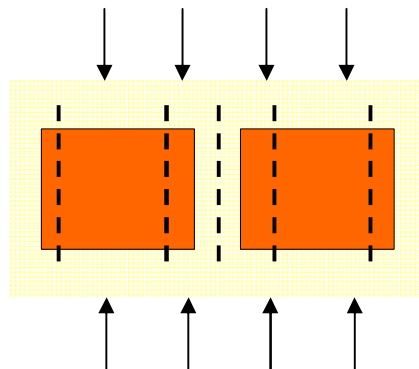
fissuration des joints et des blocs unitaires en compression pure
